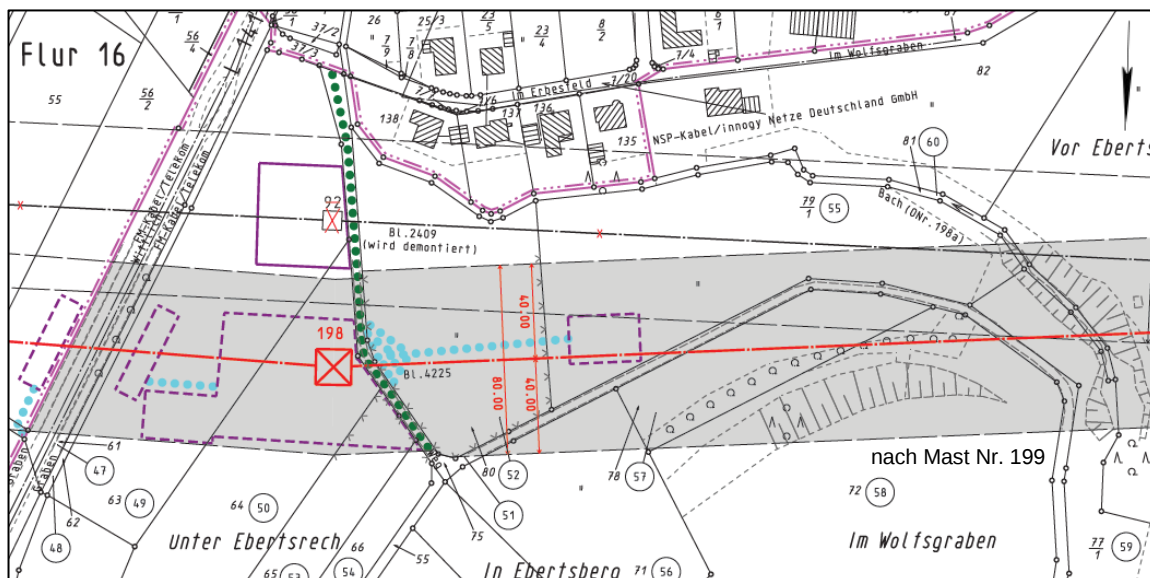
Lageplanausschnitt der Erweiterung der Zuwegung zu Mast Nr. 198.
